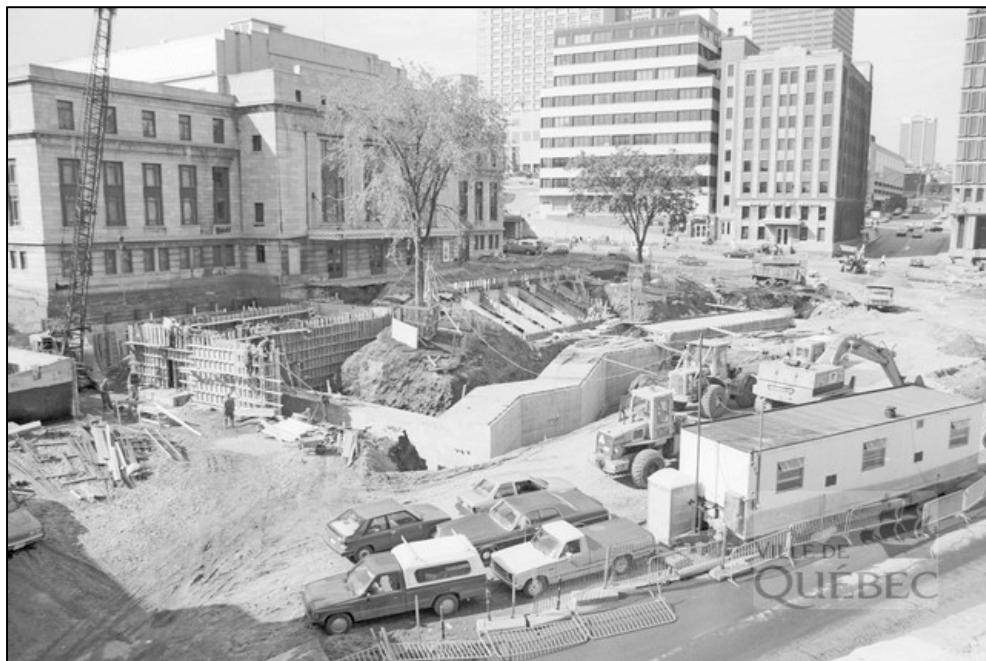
Construction de la place D'Youville, 1987 (AVQ Q-C5-IC-N028988)
